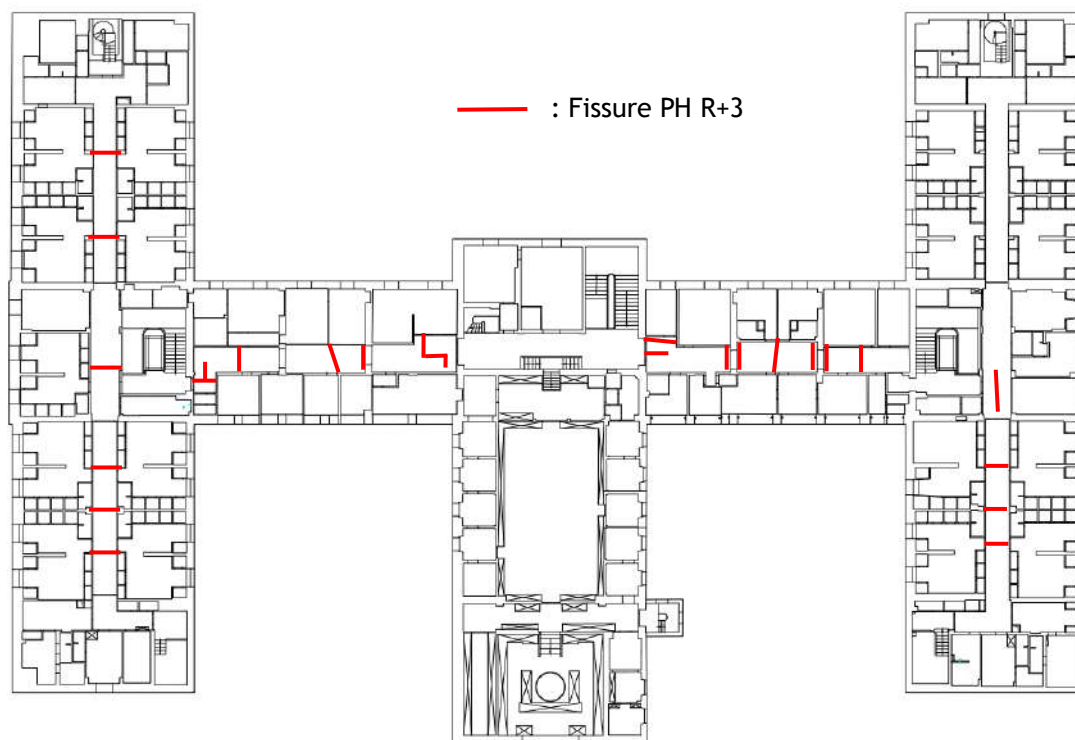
Localisation des fissures au PH R+3 - Fond de plan géomètre
